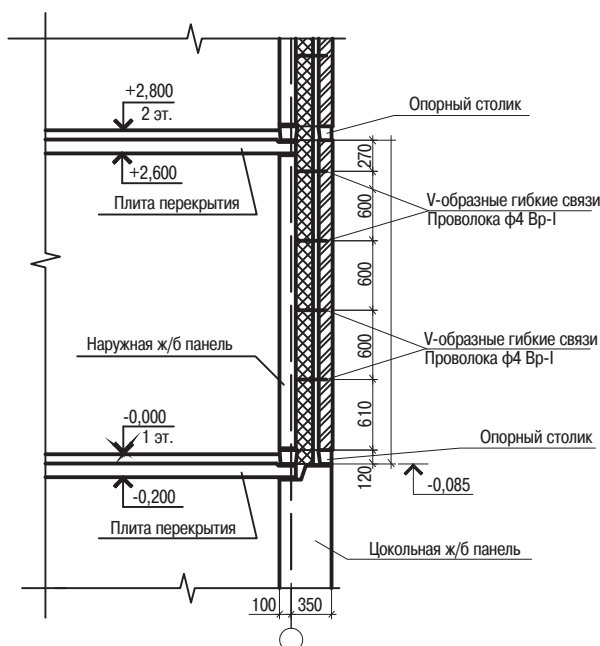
Поперечный разрез наружной стены жилого дома серии 121 У
